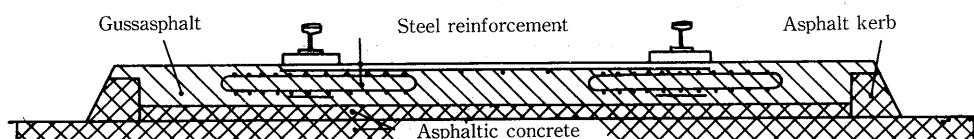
ドイツ インゴルstadtにおけるフルデプス施工断面図
